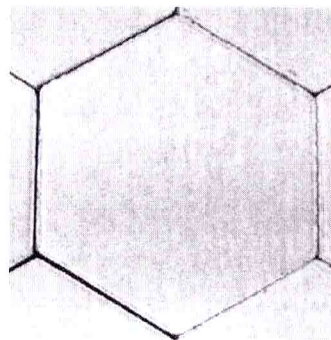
"Blokret", ou lajota sextavada em concreto pré-moldado. – Fck 35 Mpa.
